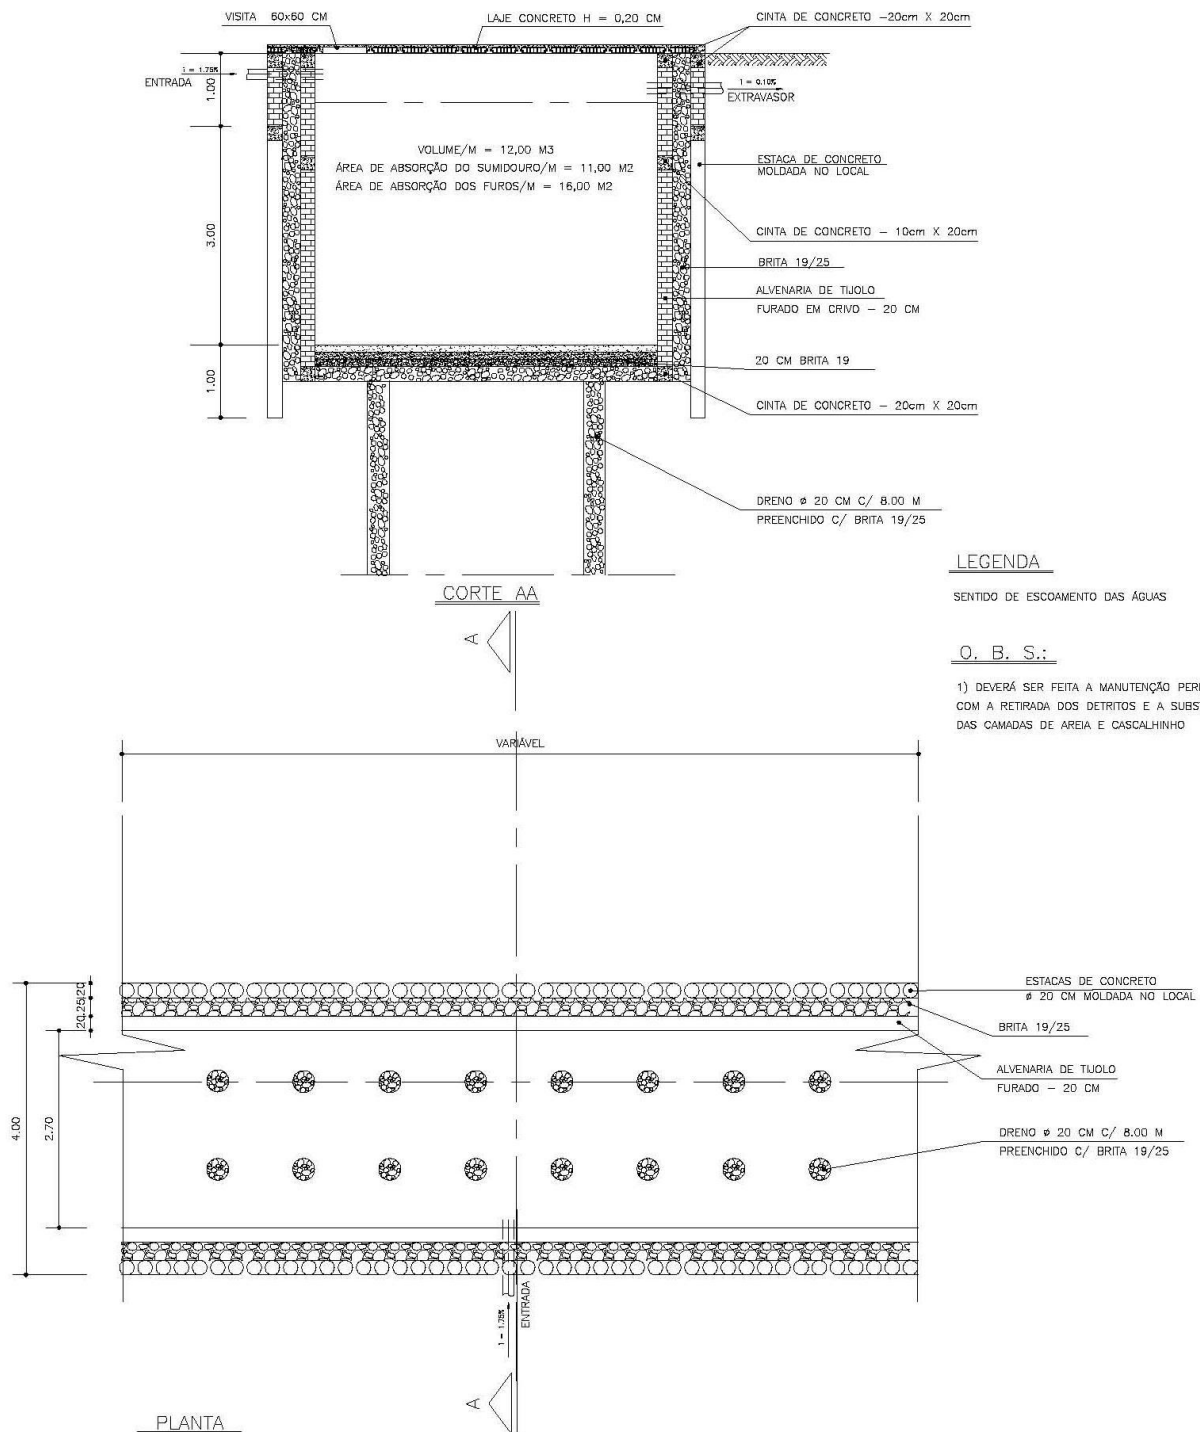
Poço de infiltração retangular com estaca e dreno profundo
